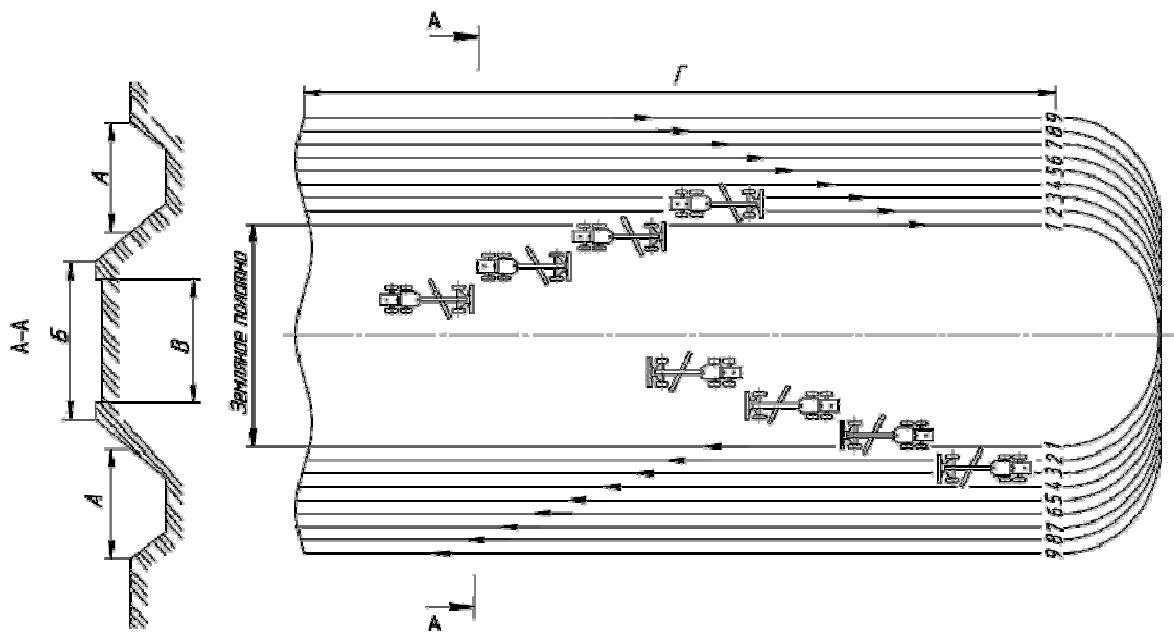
Схема работы автогрейдеров при возведении насыпи из боковых резервов (стрелка показывает направление движения парка): А - ширина резерва; Б - ширина насыпи; В - ширина корыта; Г - рабочая длина захватки; Н- высота; 1-9 - валики, вырезаемые из резерва.
